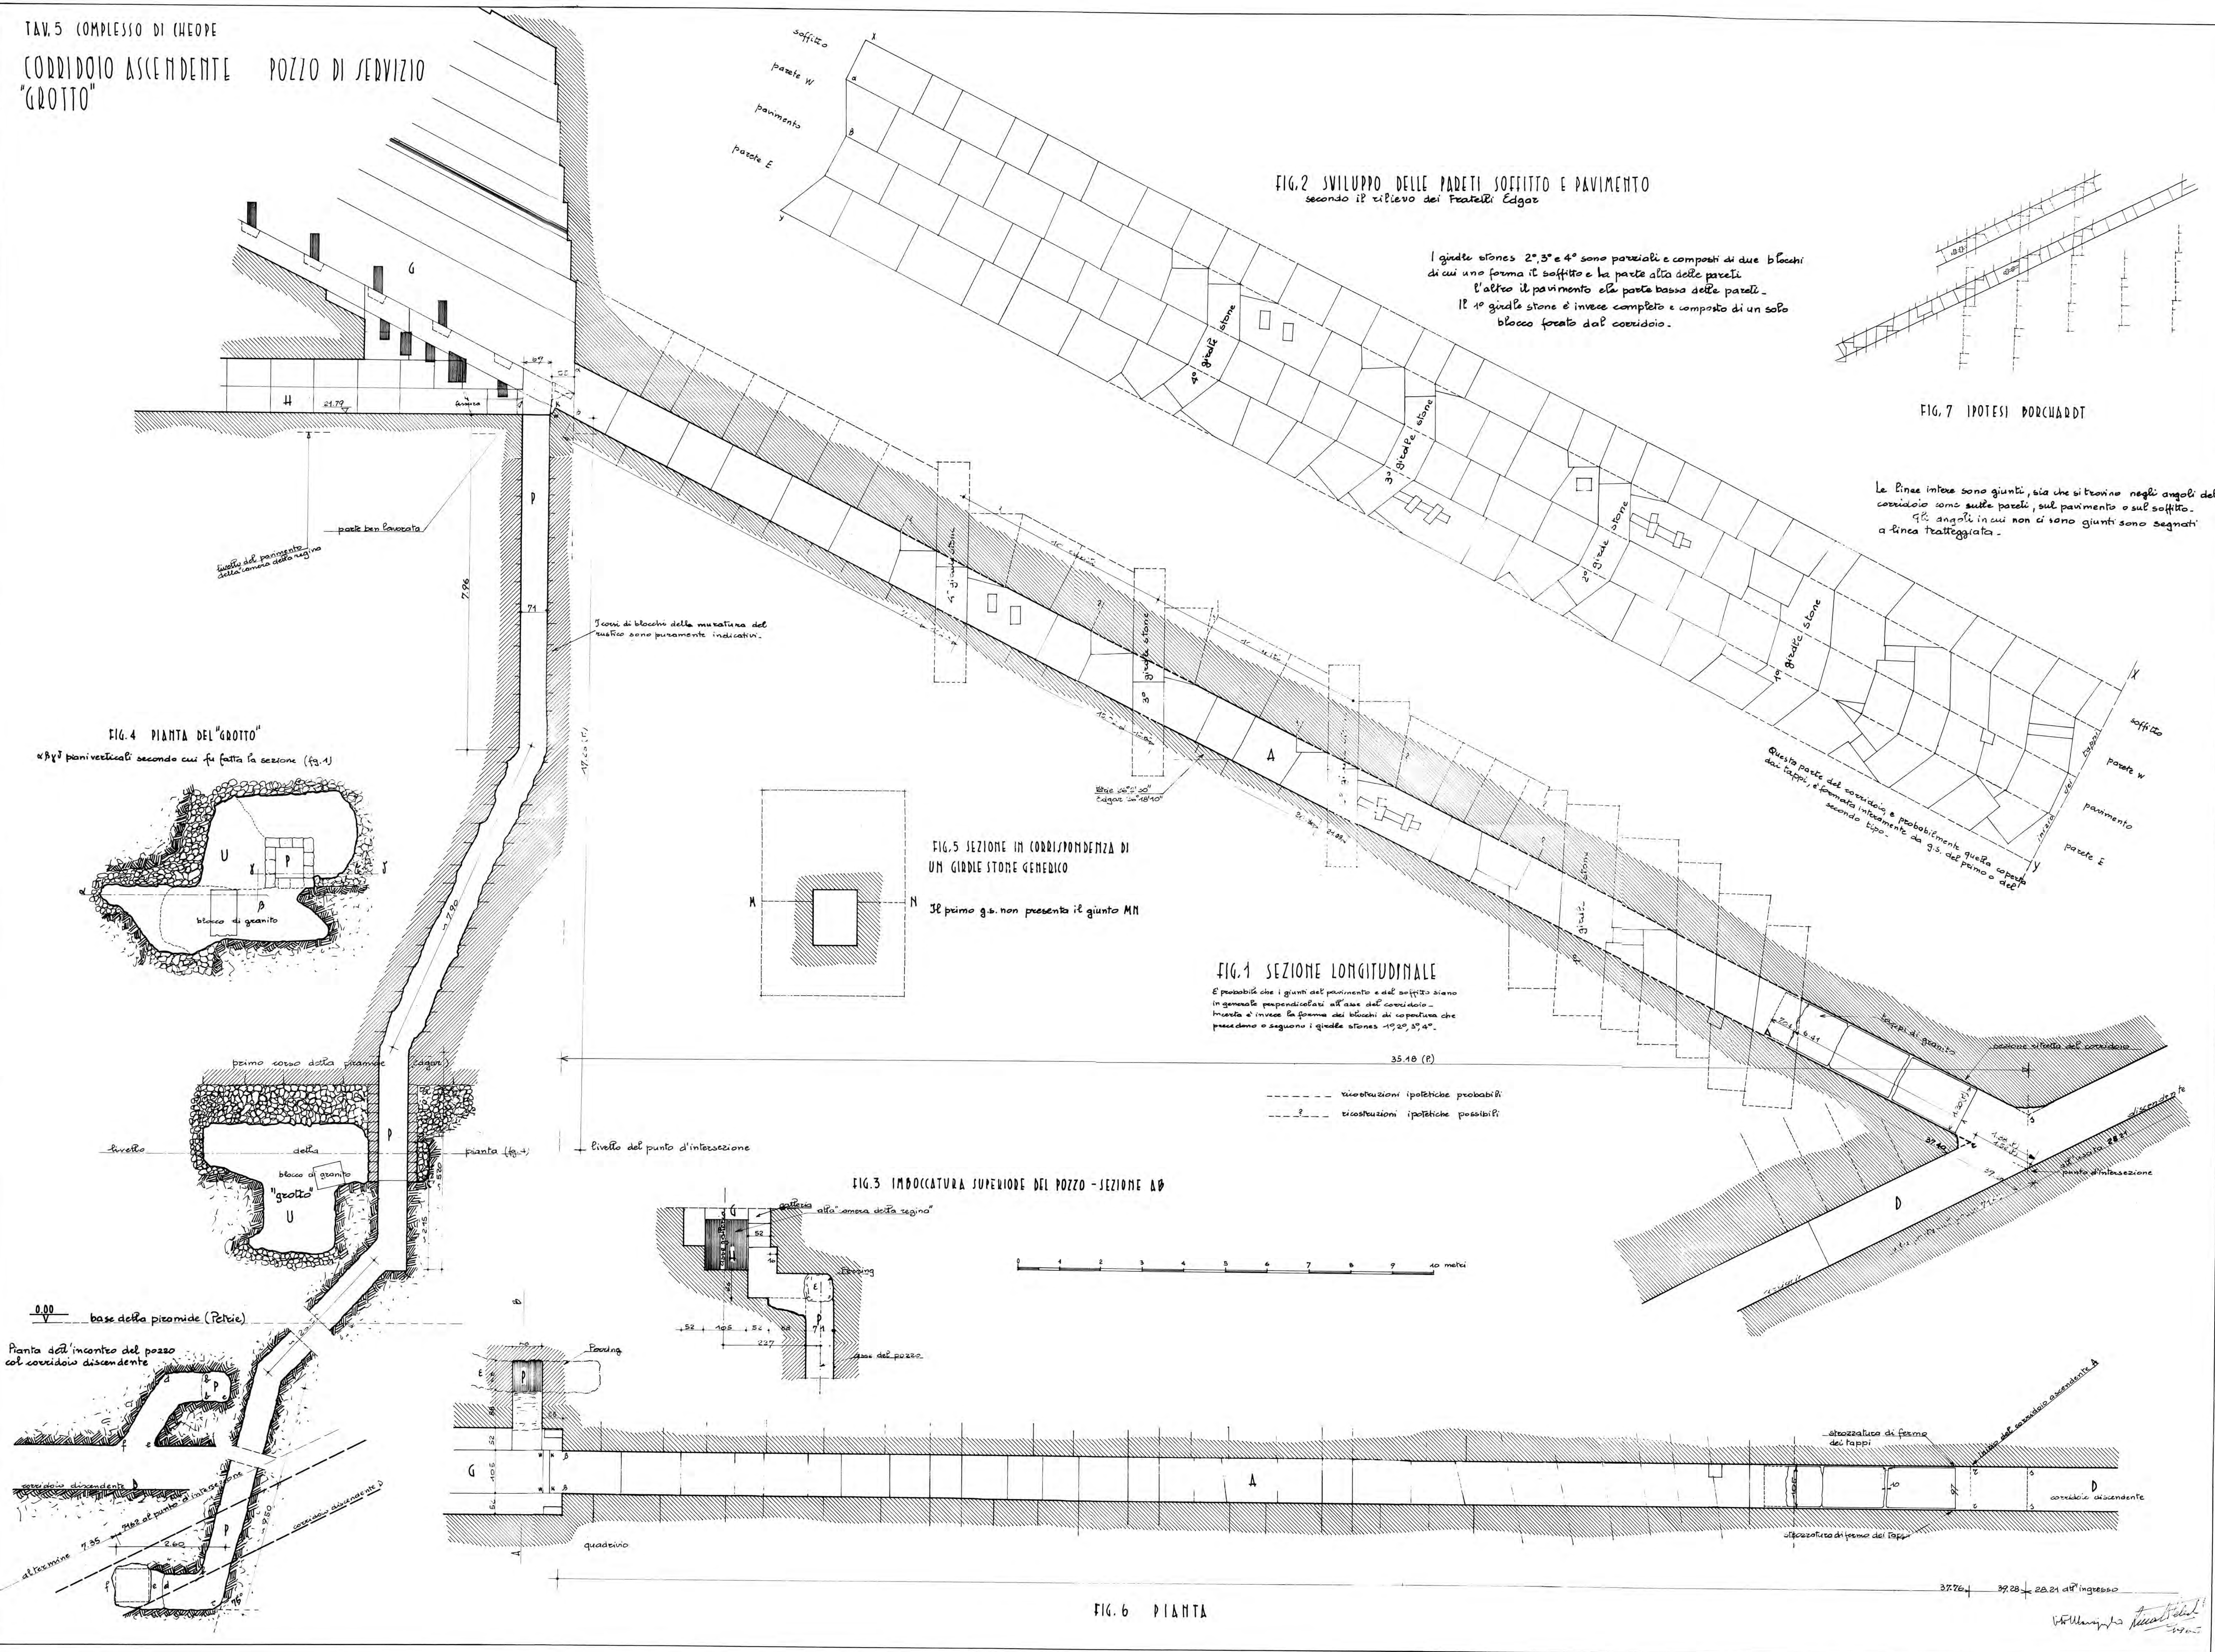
SVILUPPO DELLE PARETI SOFFITTO E PAVIMENTO secondo il rilievo dei Fratelli Edgar
